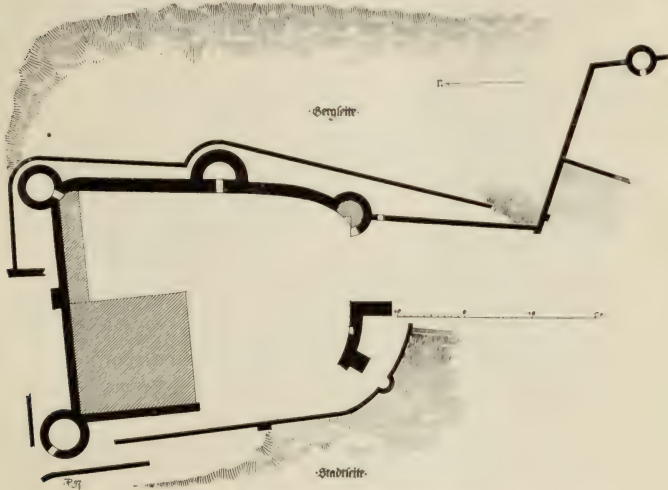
MünsterEIFEL. Grundriss der Schlossruine
